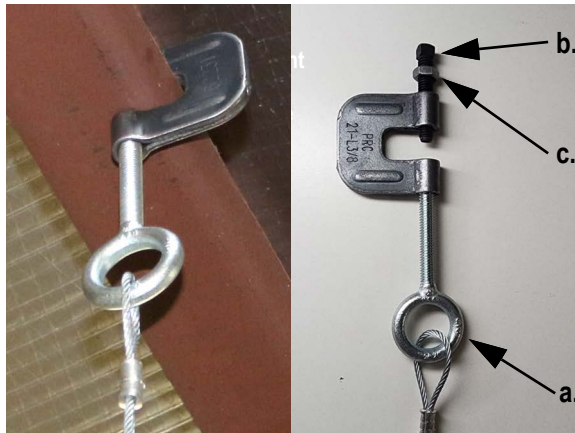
Fixation du serre-joint de la poutre à la structure du toit
